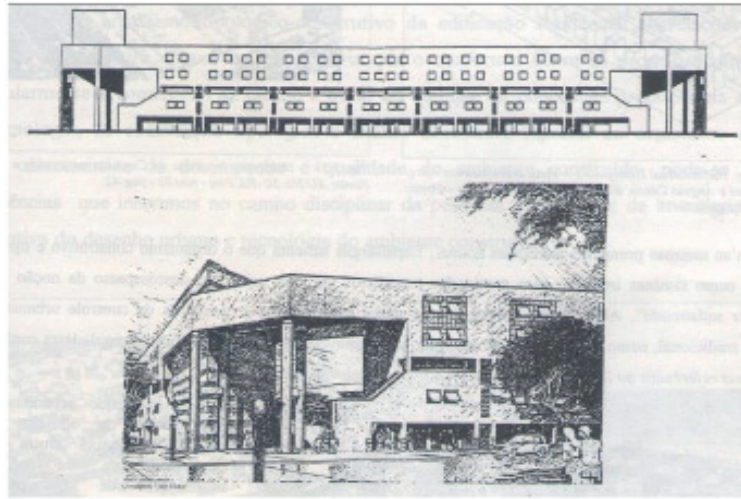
Conjunto Vila Mara – Vista da Articulação – Praça de acessos horizontais-verticais de pedestres – São Paulo – Arq. Padovano e Vigliecca
